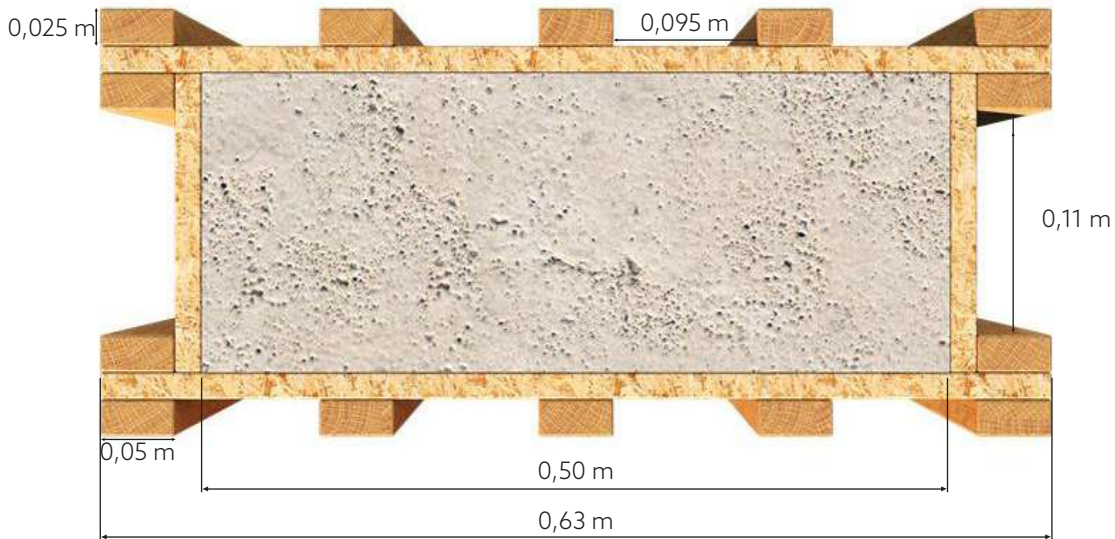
Fôrma de madeira com posição de sarrafos para pilar
